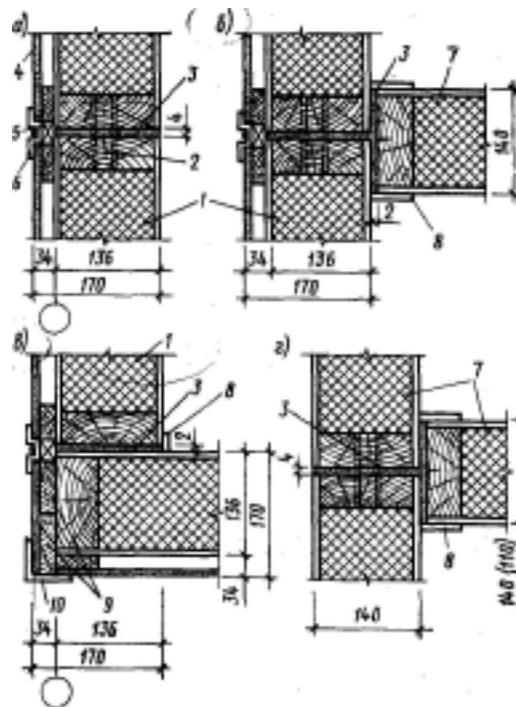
Конструкция вертикальных швов в клефанерных панелях наружных и внутренних стен:
